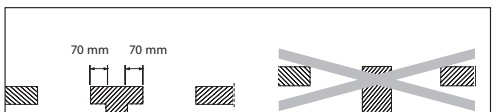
PRZYGOTOWANIE OTWORU W MURZE
